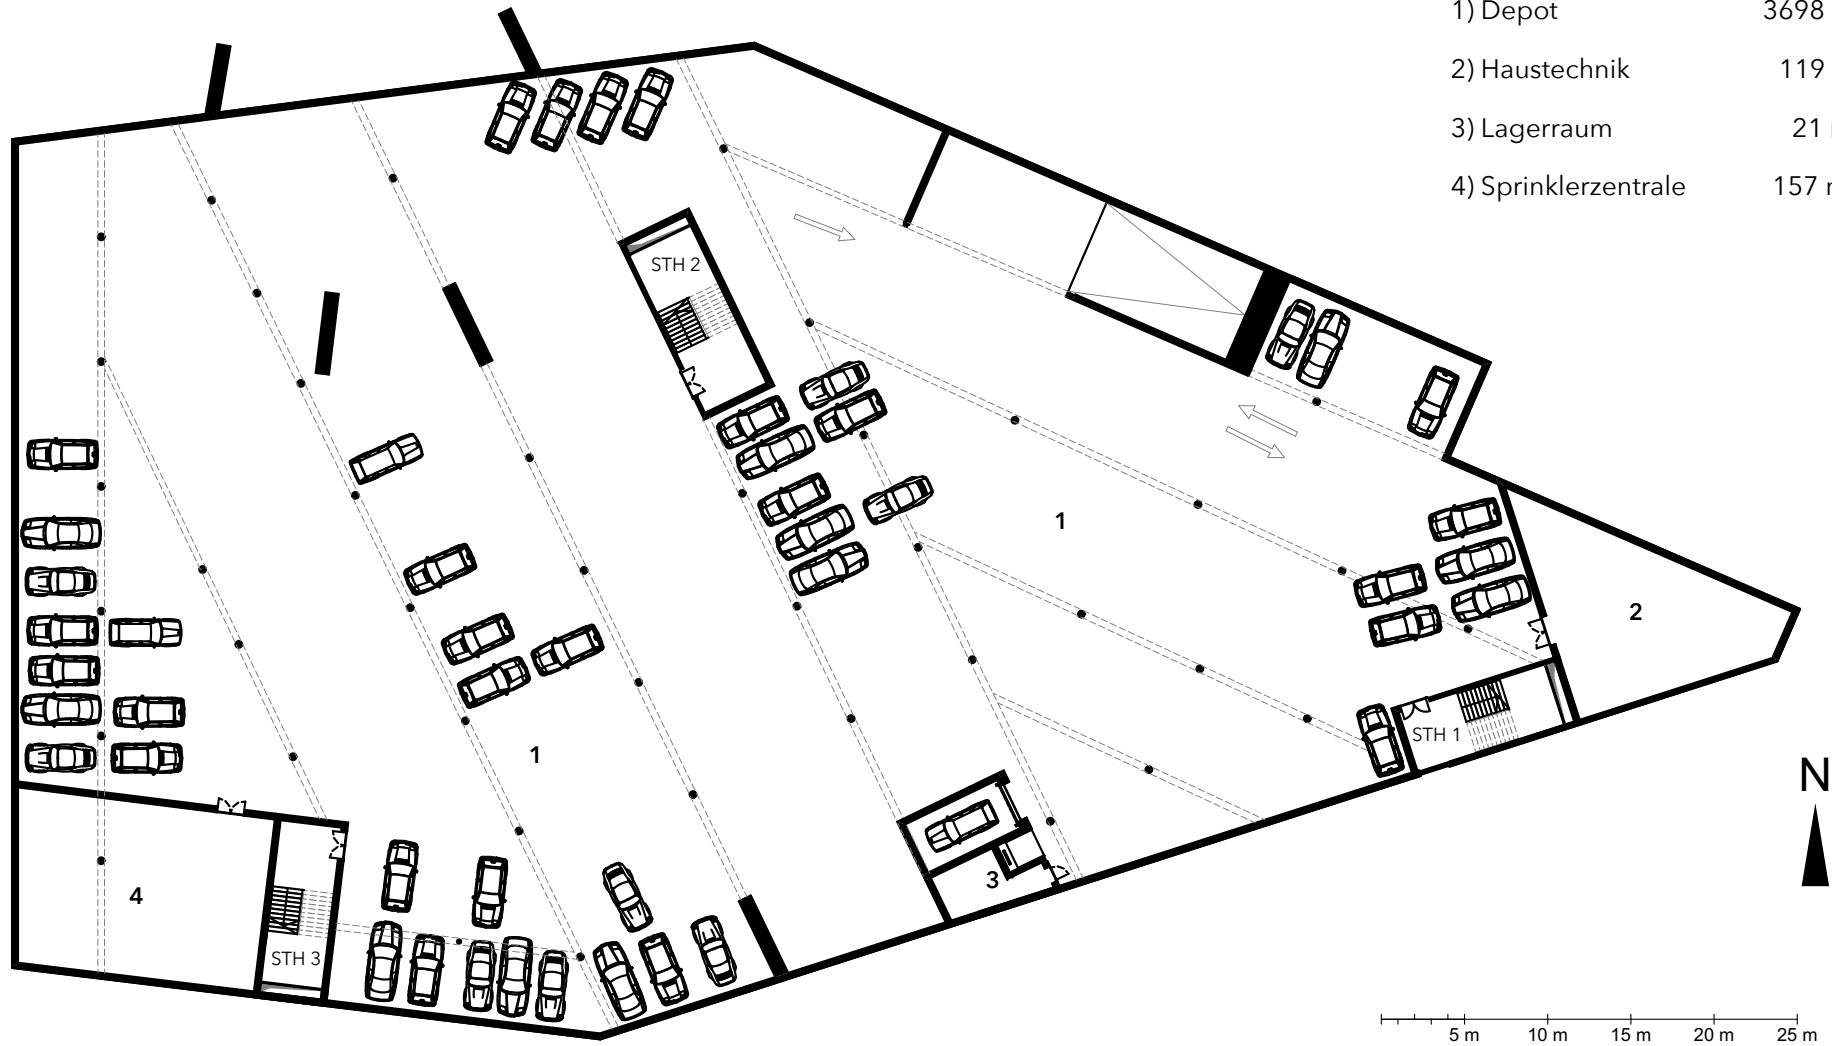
, Grundriss UG2, eigene Darstellung
